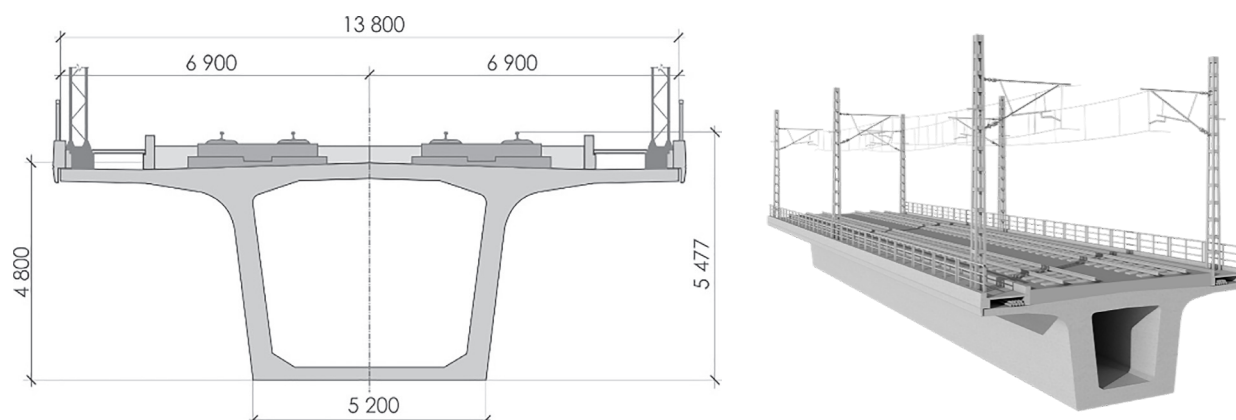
Поперечное сечение пролетного строения полной длиной 50 м из предварительно напряженного железобетона
